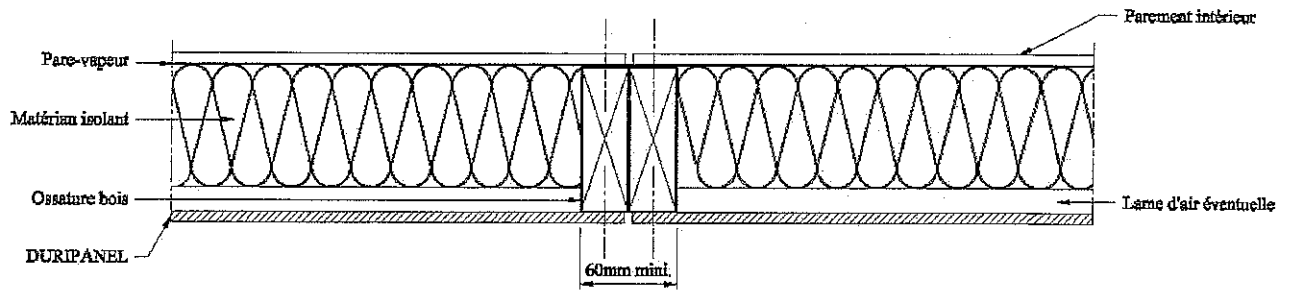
Coupe sur montants d'ossature accolés avec joint vertical
